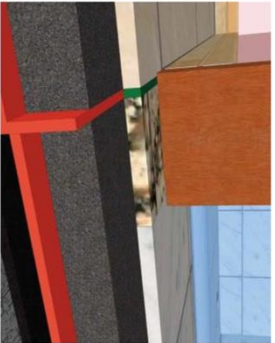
Detalhe padrão da interface manta/impermeabilização/ralo
